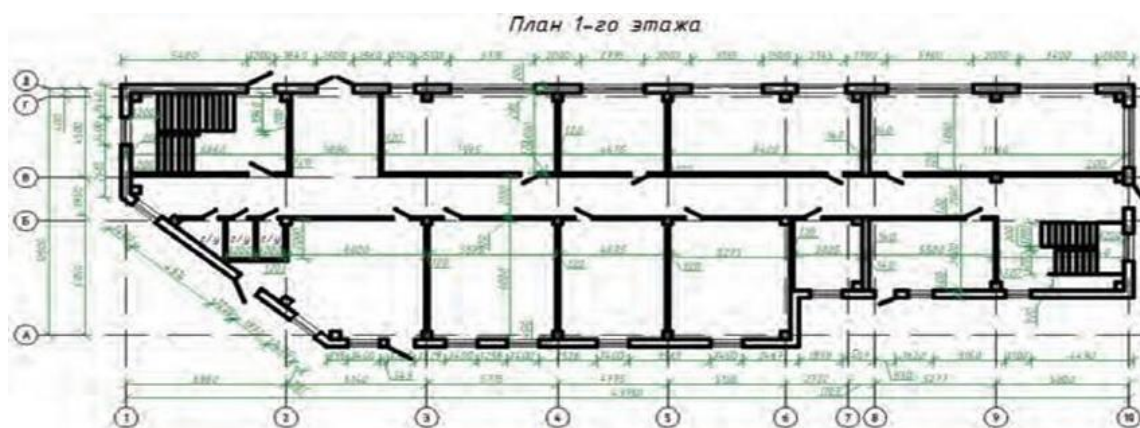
Поэтажный план 1-го этажа перестроенного здания
